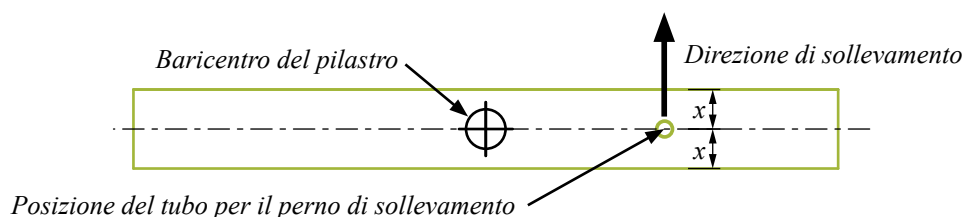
Installazione del tubo per il perno di sollevamento sopra il baricentro.
